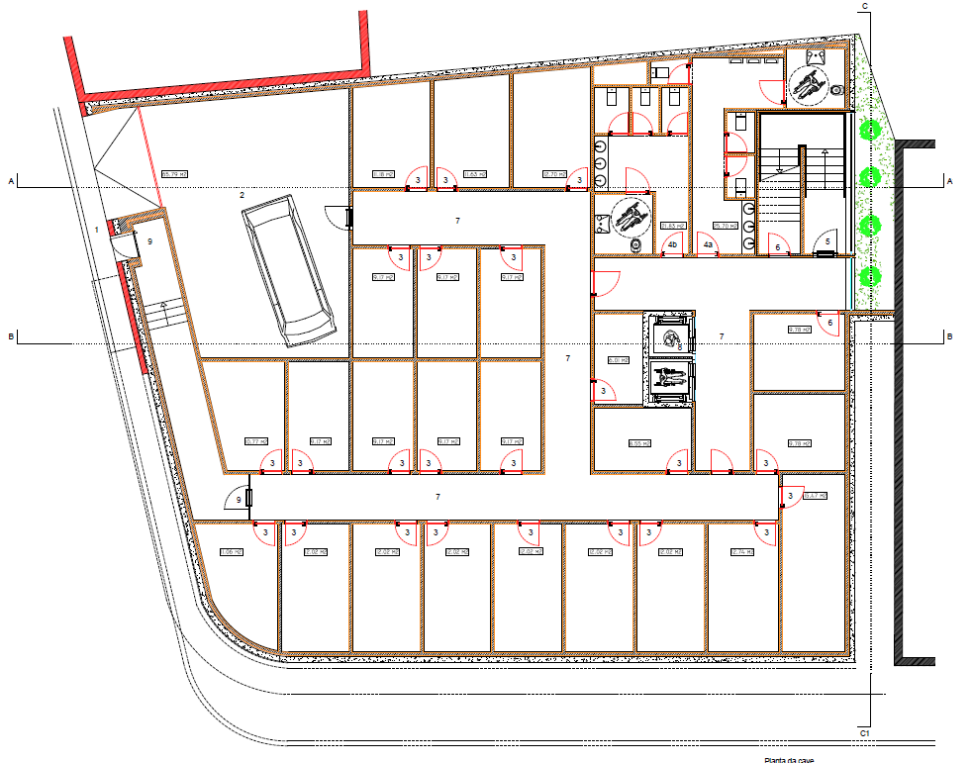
Planta da cave. Fonte: Corcovado Construções.
